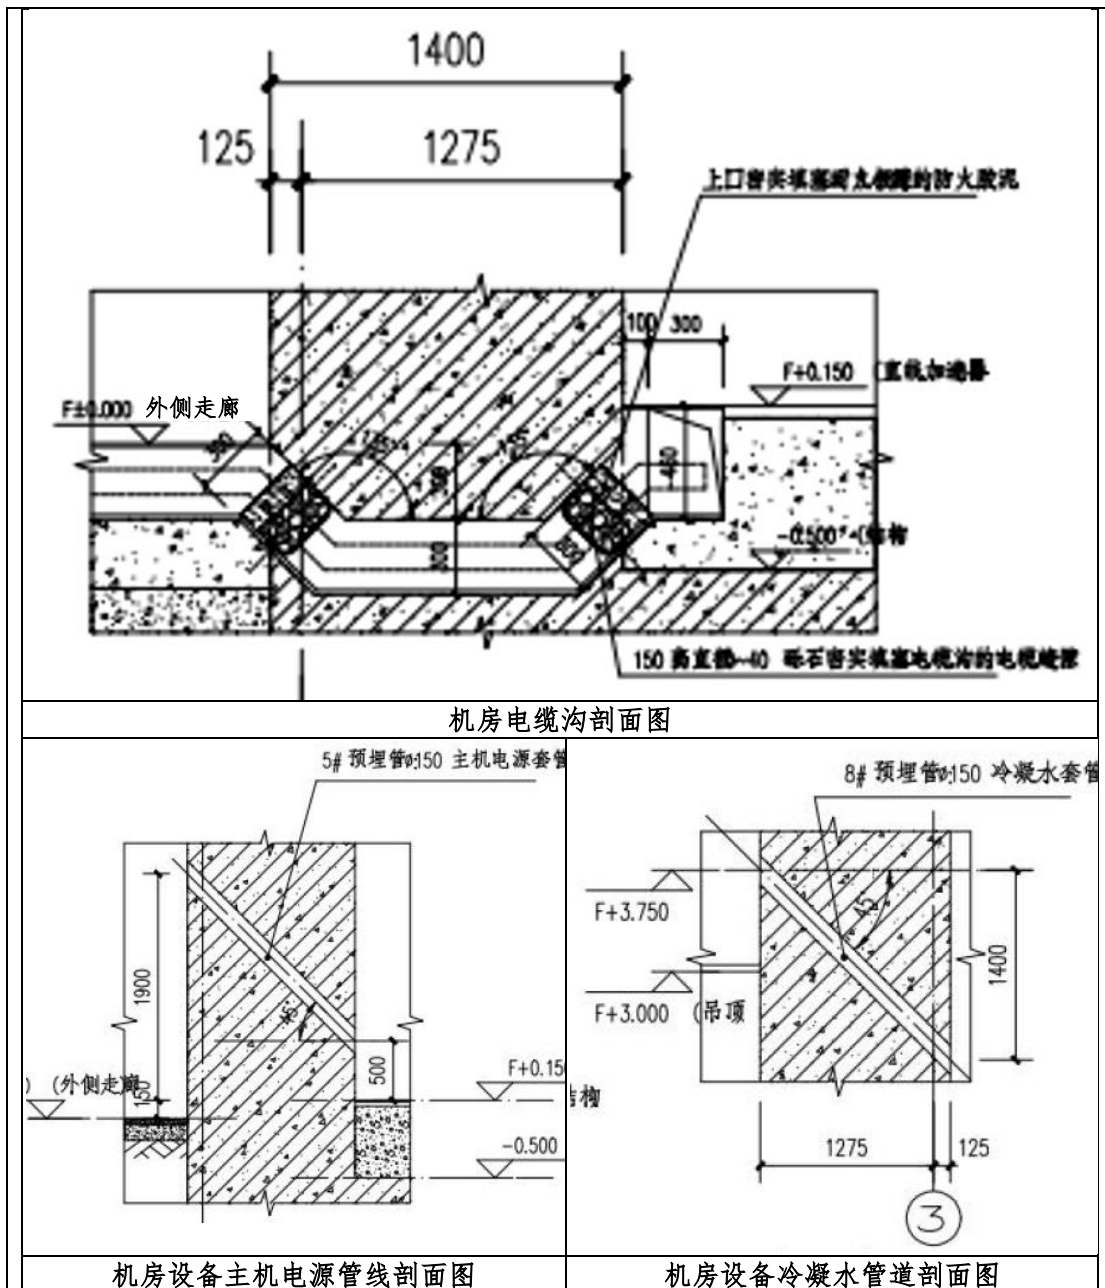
本项目加速器机房各类穿墙管道剖面图
